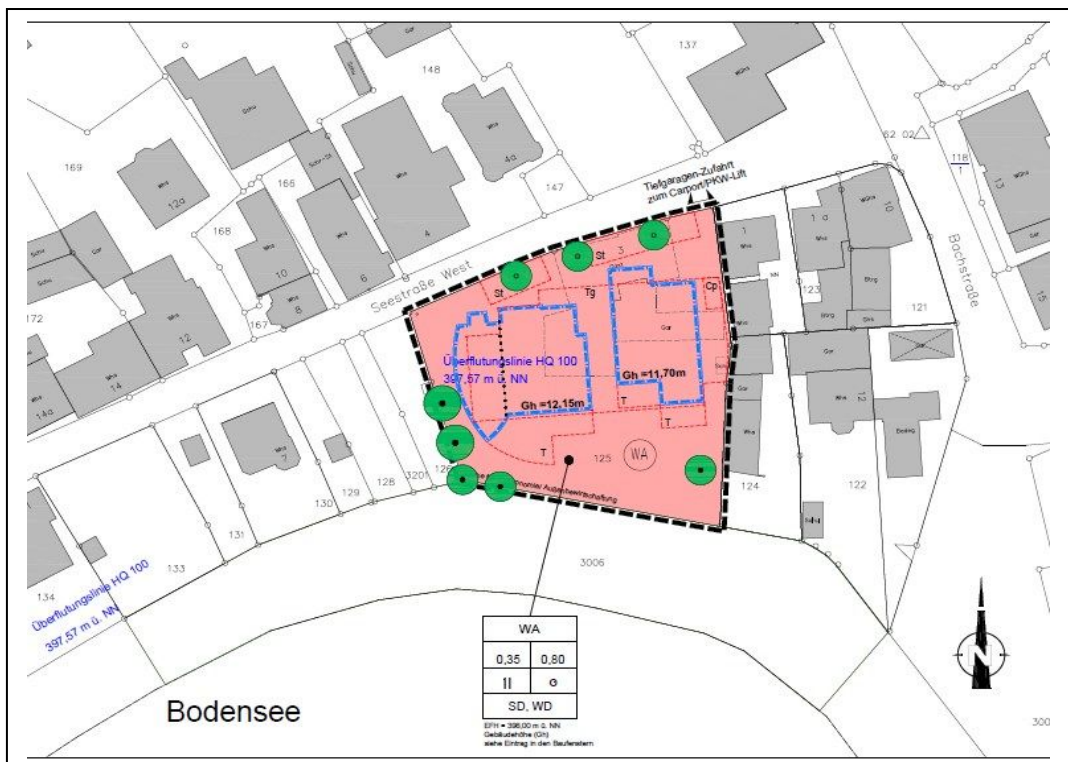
Lageplan mit Eintrag des Plangebietes in Immenstaad (HORNSTEIN in lit. 2020)
